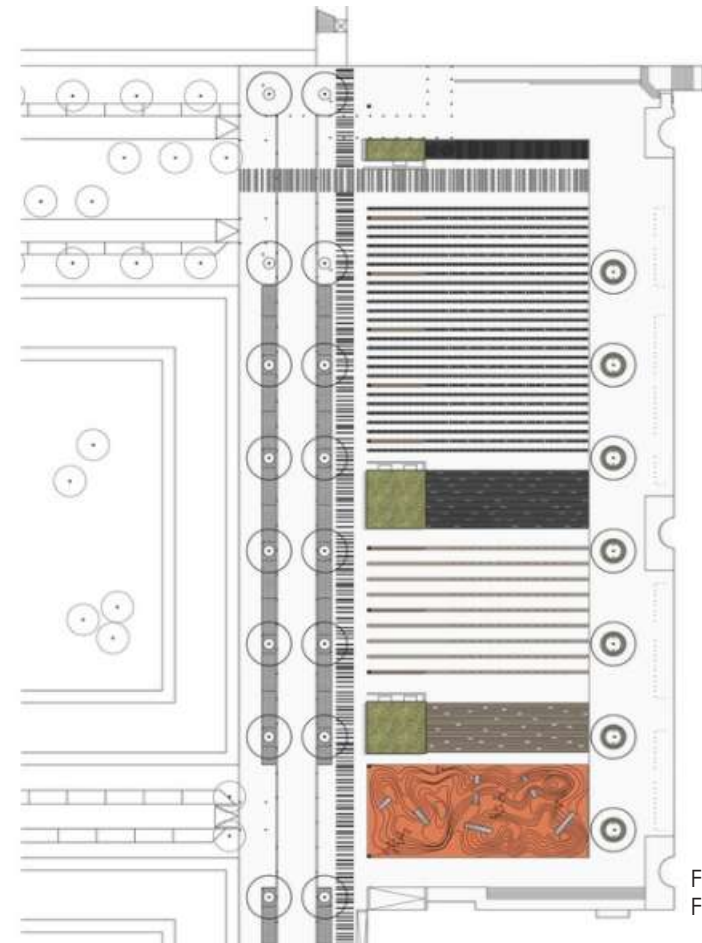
Planta Baixa - Fonte: Archdaily, 2016
